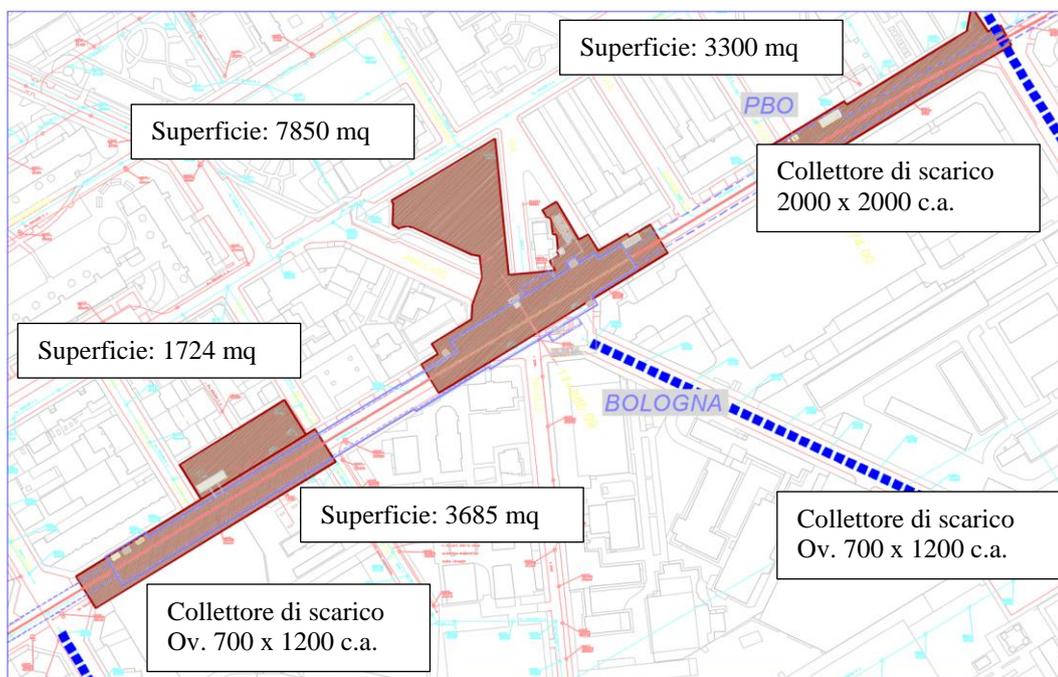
Aree di cantiere – Stazione Bologna – FASE 2
